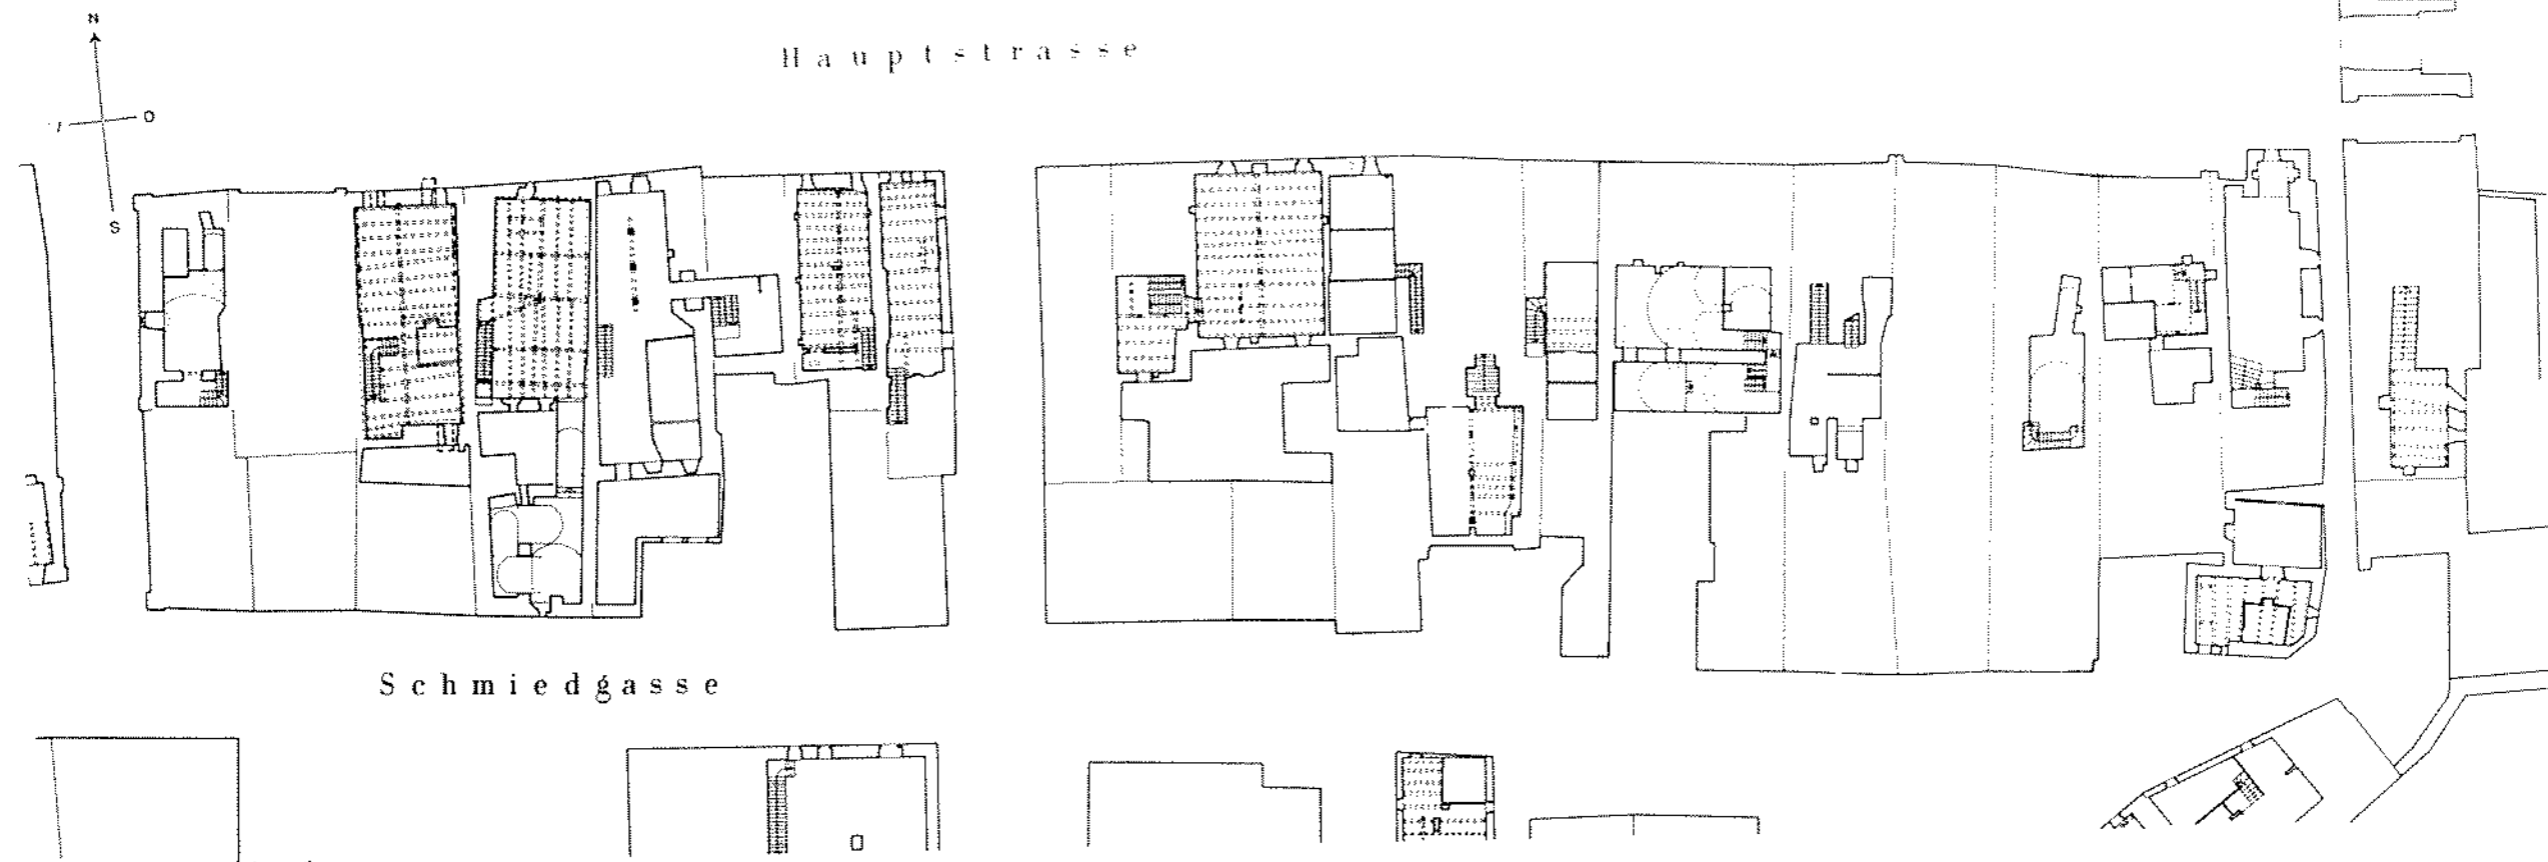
Kellerplan 1985/86. Der Ausschnitt mit Kellergrundrissen am Markt (Hauptstrasse) lässt die Entwicklung im Weichbild der Stadt erkennen: älteste Keller (ab 14. Jahrhundert?) 20 bis 30 Fuss hinter der heutigen Gassenfront, Ausbau (ab 15./16. Jahrhundert) bis zur Gassenfront, gewölbte Grosskeller ab 16./17. Jahrhundert.
